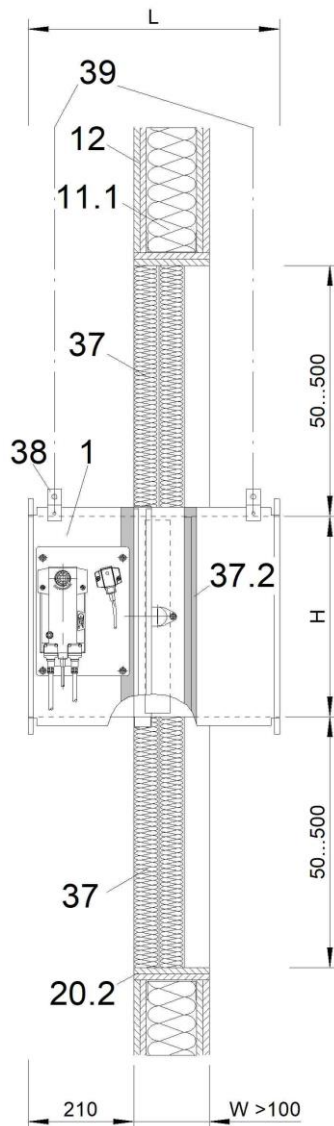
montaggio nella parete con struttura di supporto metallico (spessore parete > 100 mm)
